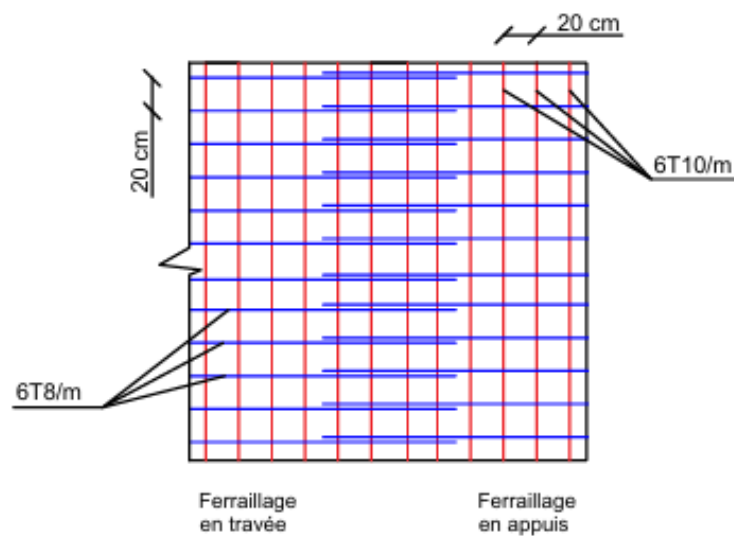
Ferraillage de la dalle pleine (sens y-y)
